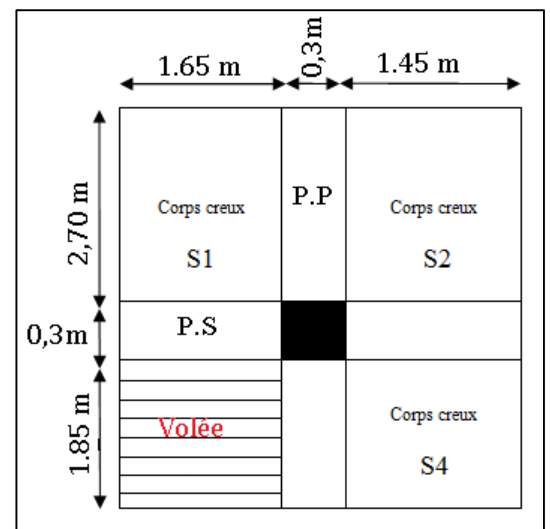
La surface afférente du poteau PD6. (Sous-sol 1 - RDC)
